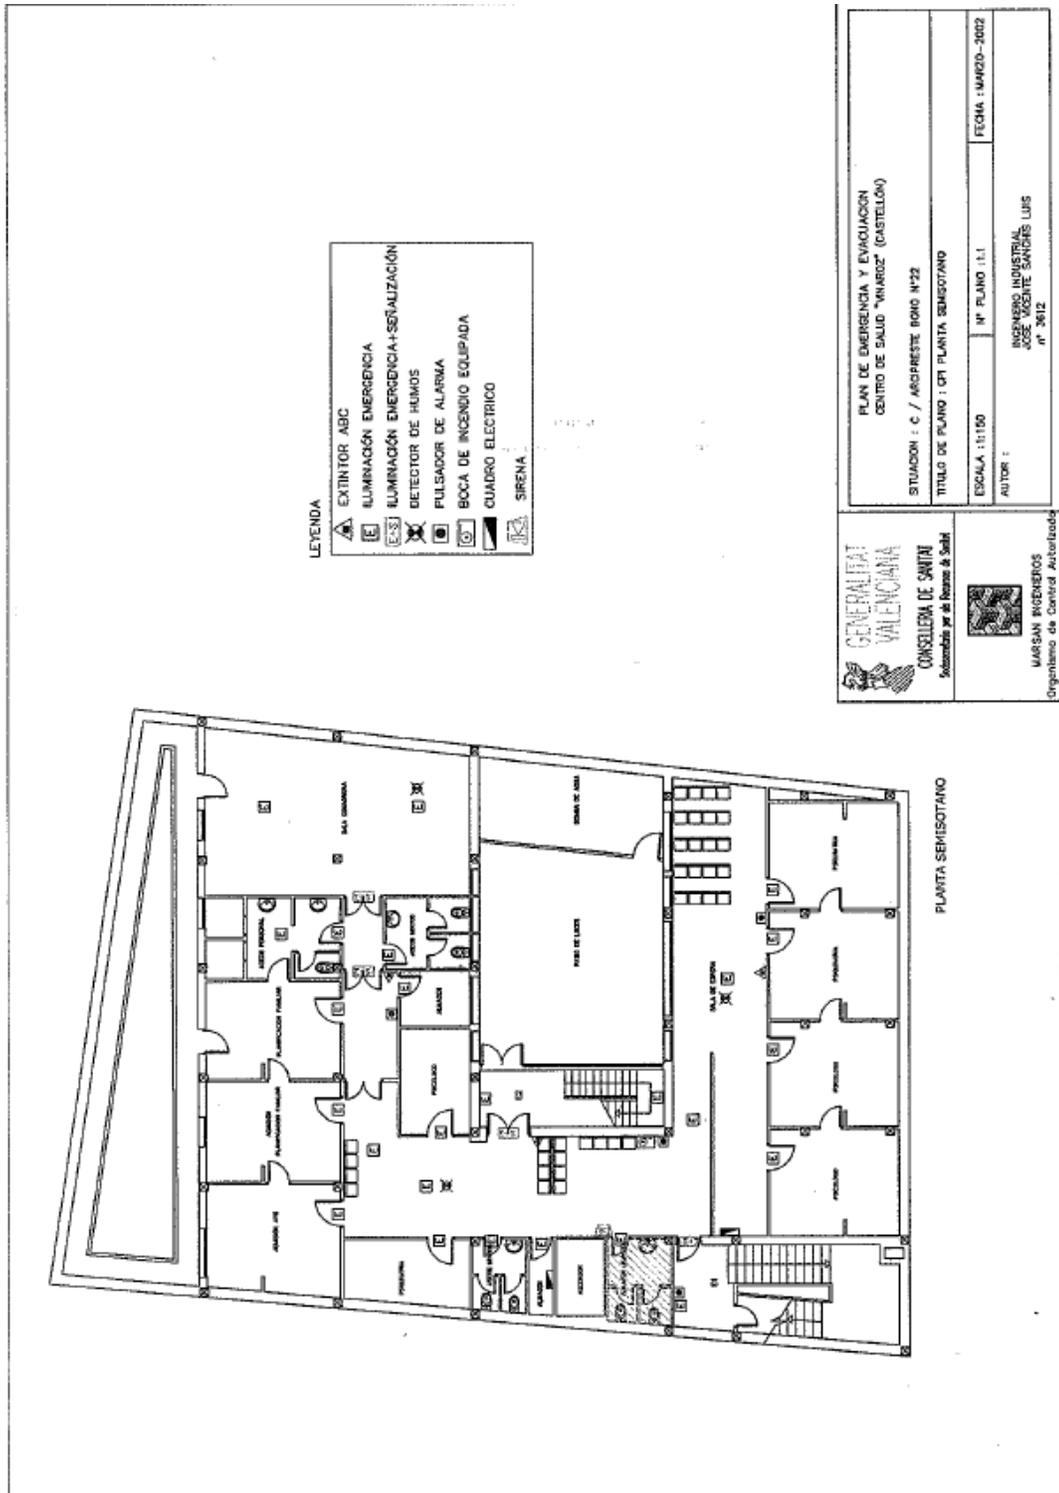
Esquema planta sótano del centro de salud de Vinaroz.
